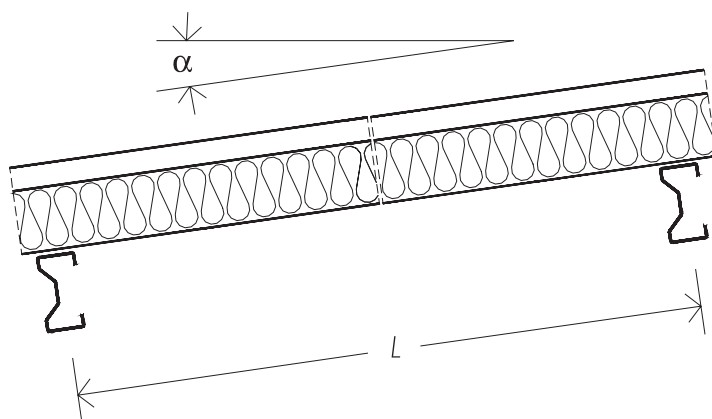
Druhy podkladních konstrukcí pro upevnění panelů Trimoterm SNV.
